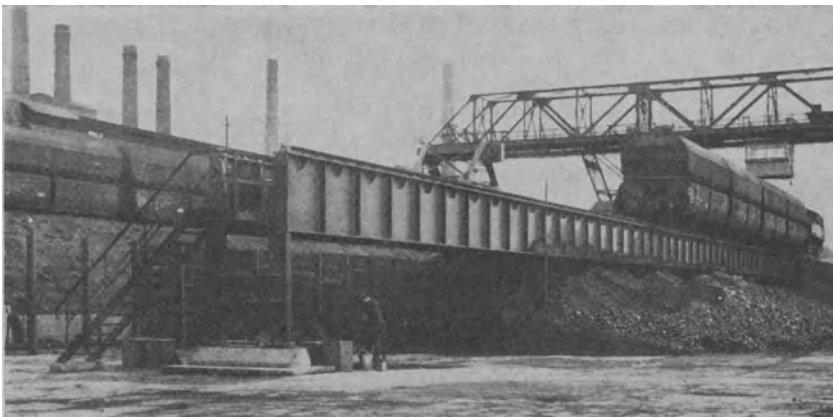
Gänzlich geschweißte Vollwandbrücke.
